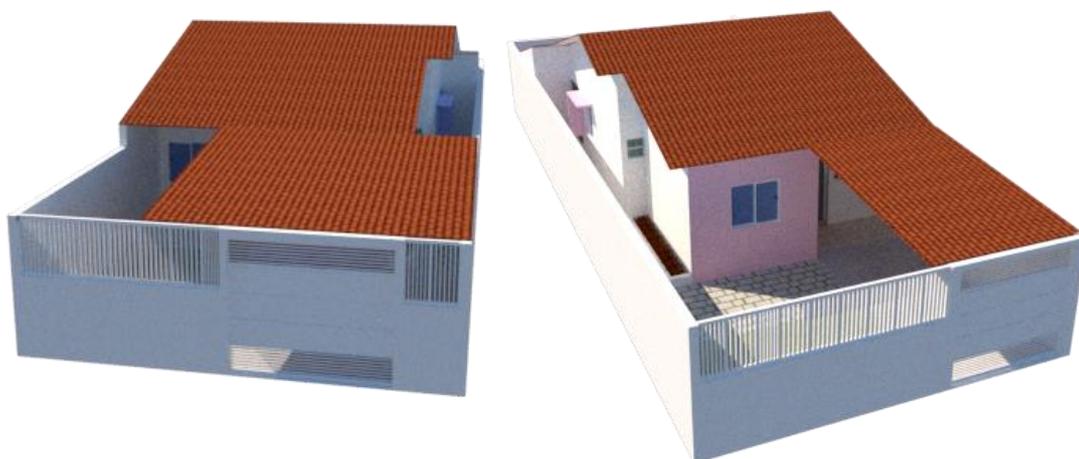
Proposta orientada à Sudeste - Fachada frontal
